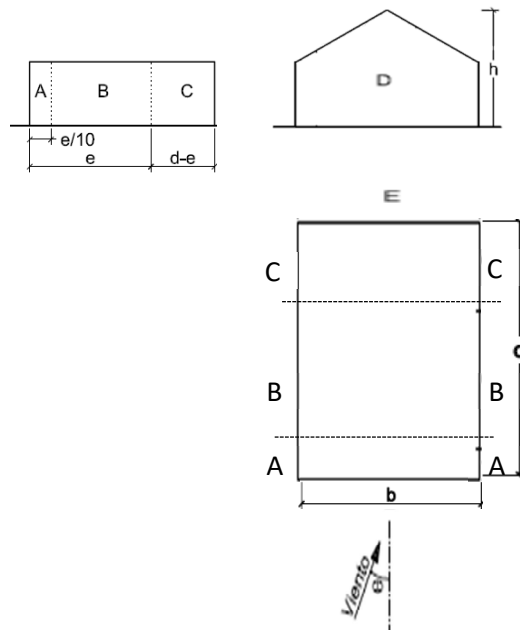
Zonas de la fachada para viento longitudinal.
